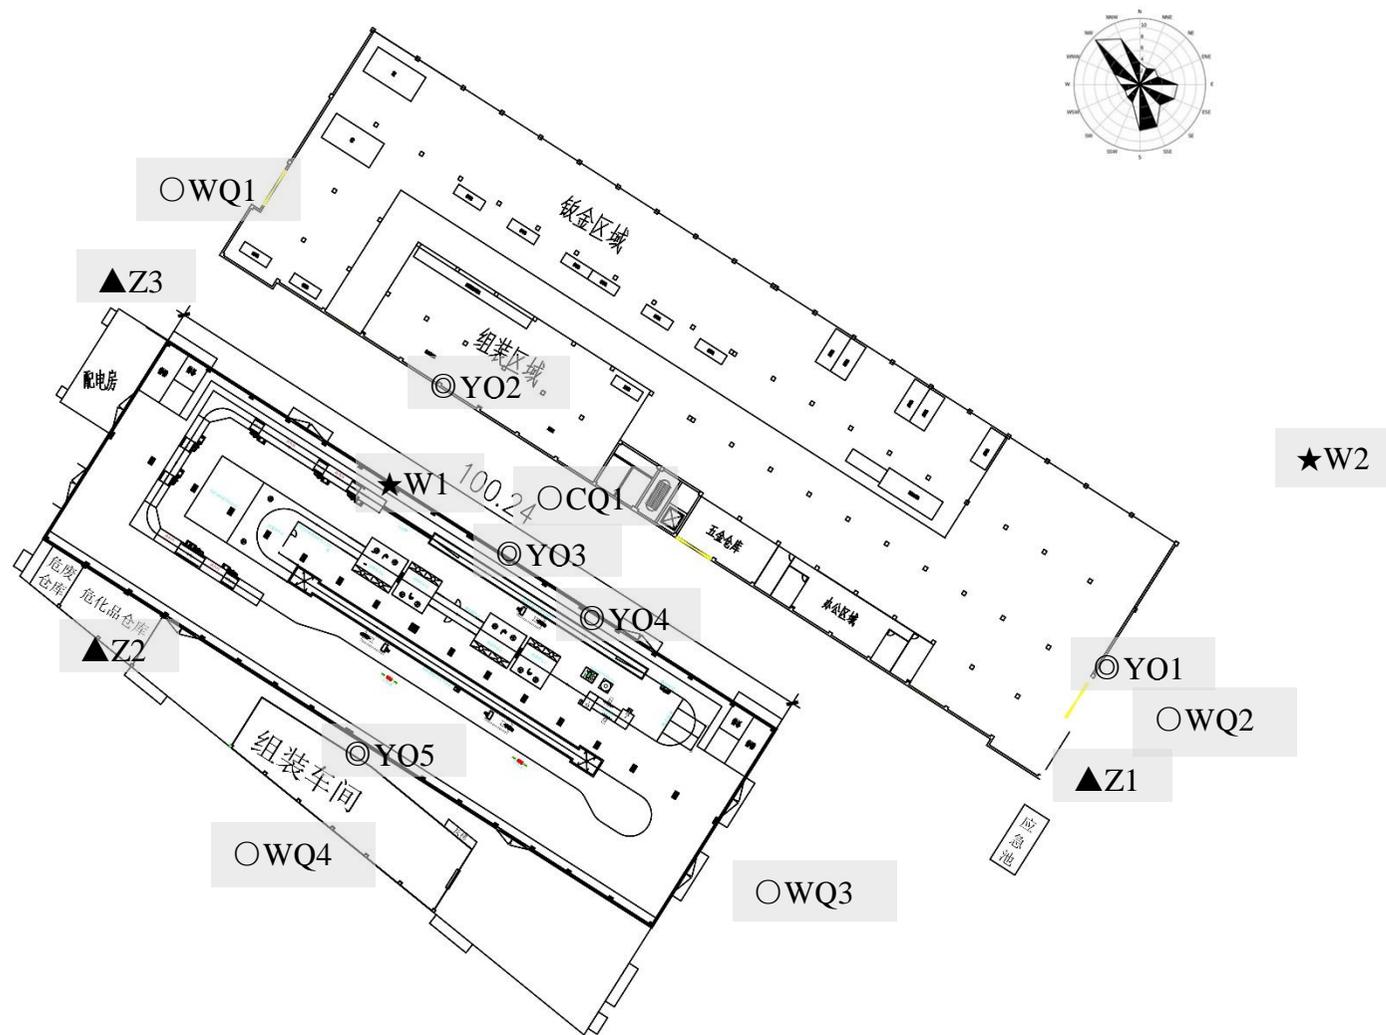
总平面布置图 (注: ▲噪声监测点位, ◎有组织废气监测点位, ○无组织废气监测点位, ★废水排放口监测点位)
